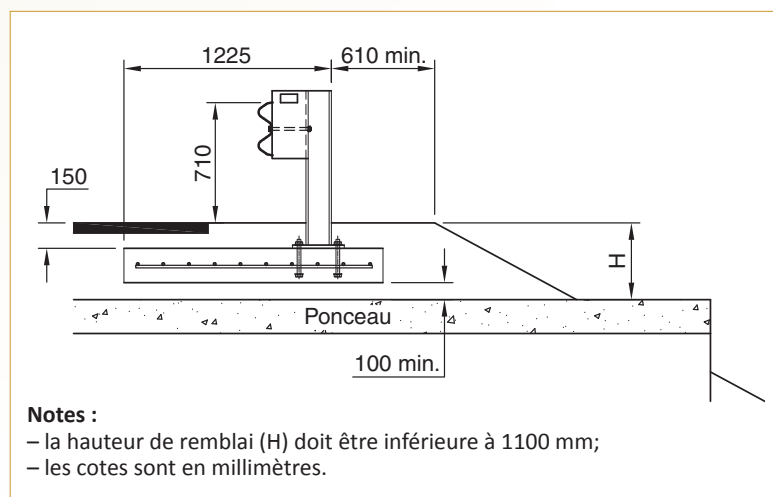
Détail d’installation de la dalle au-dessus d’un ponceau circulaire ou voûté
